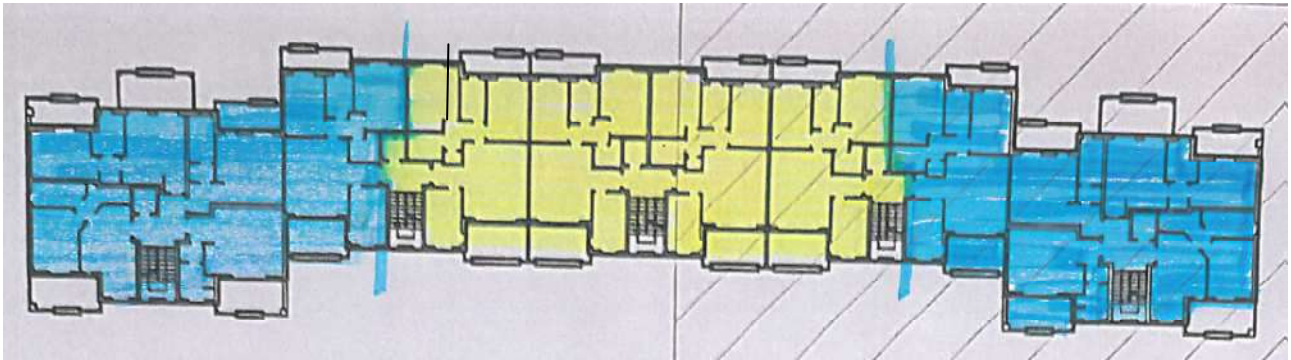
planimetria dislocazione controsoffitto (azzurro polistirolo, giallo poliuretano)
